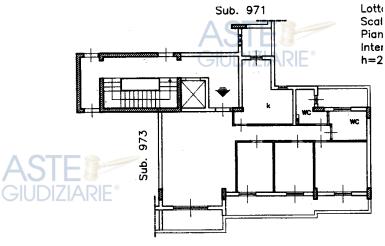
planimetria catastale dell'appartamento al settimo piano pignorato
